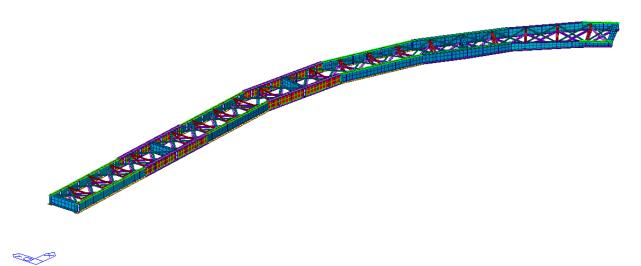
Vista 3D della carpenteria metallica (Rampa D)
